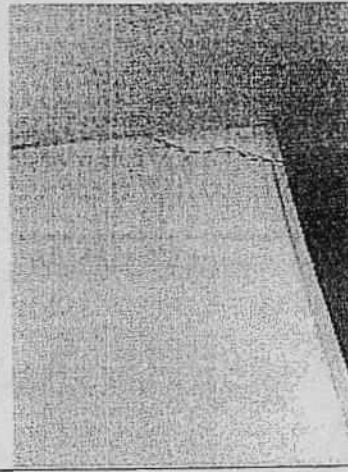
Fisuras entre vértices de muros interiores y placa de entpiso apartamento 503 fisura típica torre costado norte.
